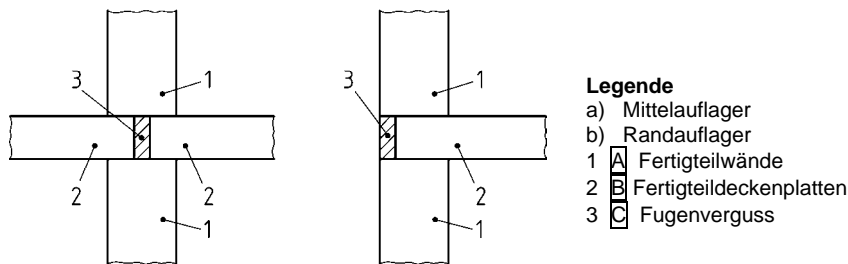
Auflagerung von Deckenplatten auf Fertigteilwänden
